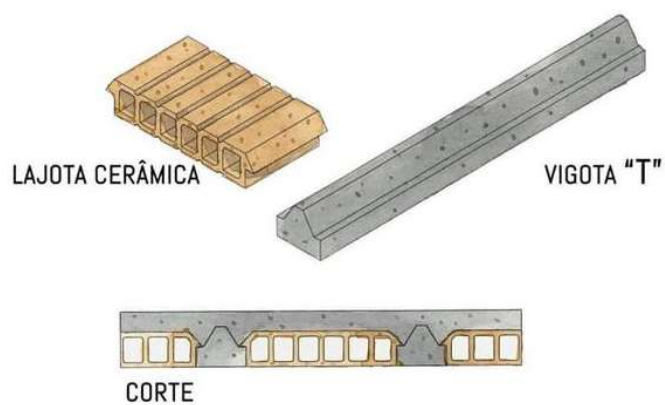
exemplo de Laje Pré-moldada com vigota T (Pinterest).
